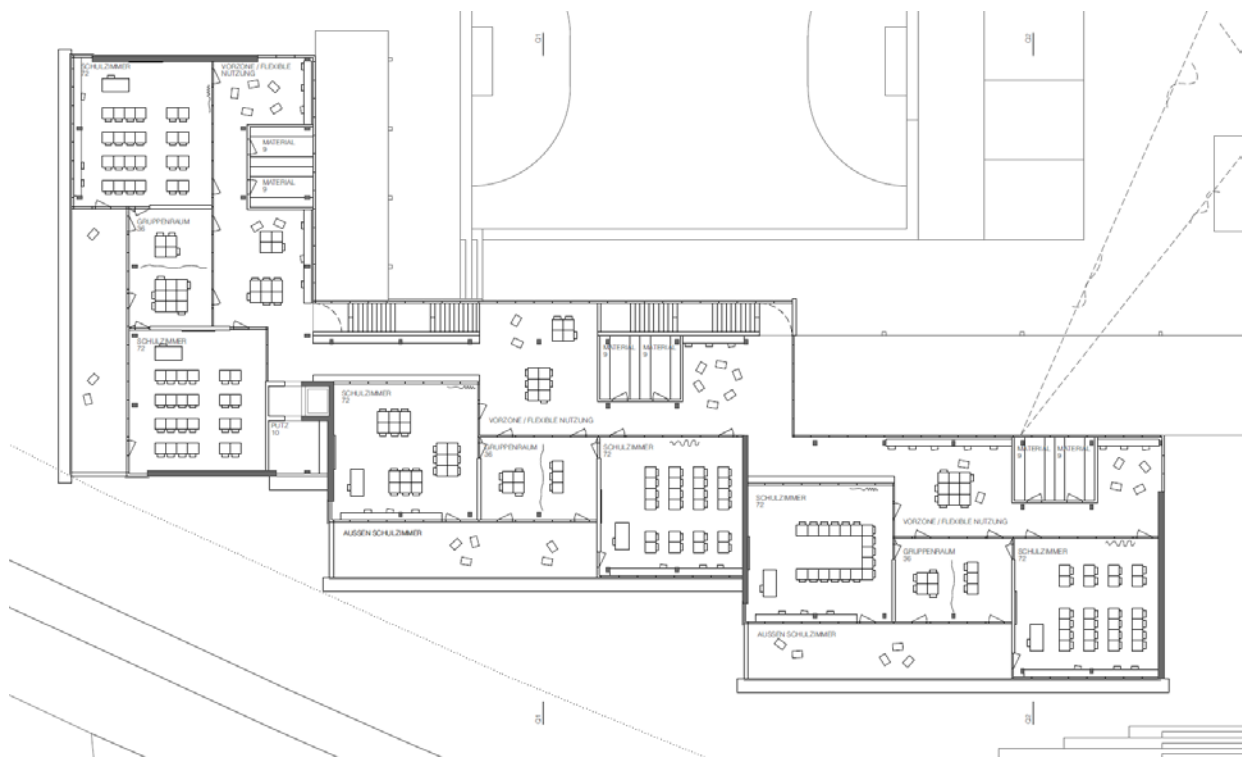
Grundriss Obergeschoss des überarbeiteten Siegerprojekts
